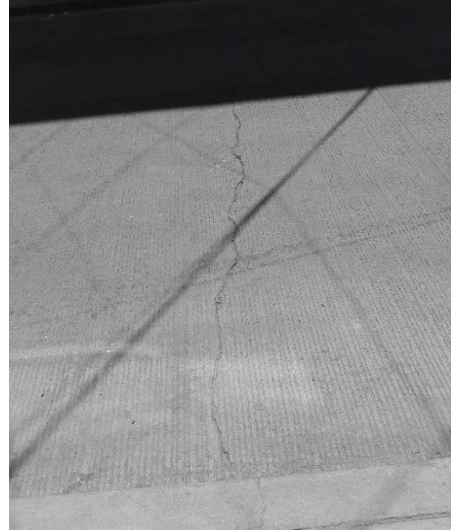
Rehabilitación Rígido – Presentan fisuras transversales en 16 losas.
